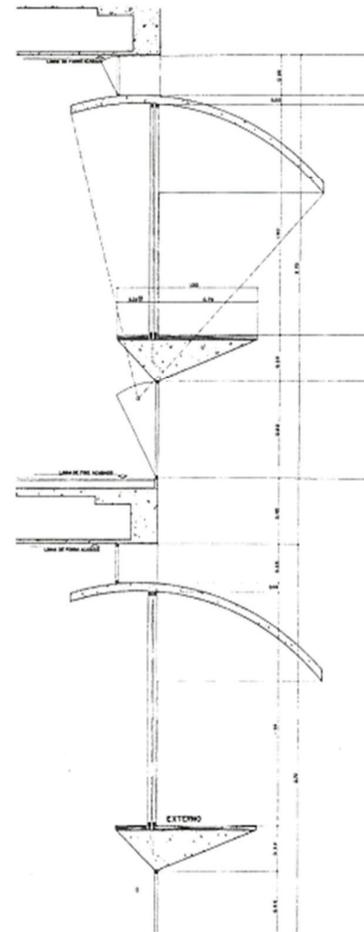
Detalhe do brise feito para a fachada frontal do edifício
